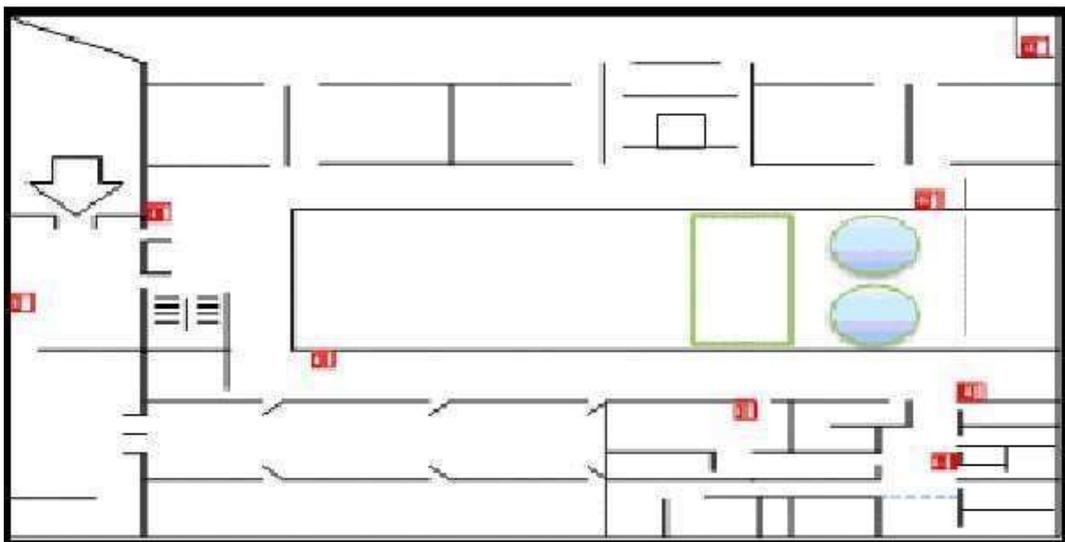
Plano de ubicación de extintores. Fuente: Autor.
